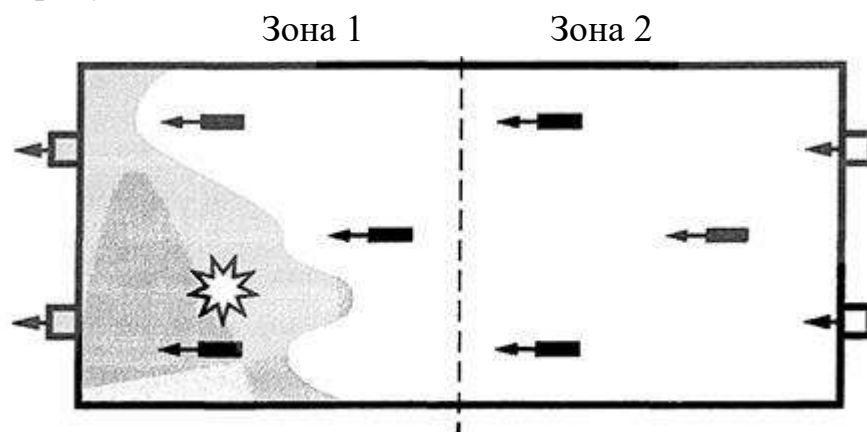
Схема автостоянки, оснащенной системой струйной вентиляции на базе центробежных струйных вентиляторов
